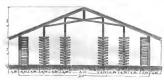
Coupe on travers d'un séchoir à tuyaux.
